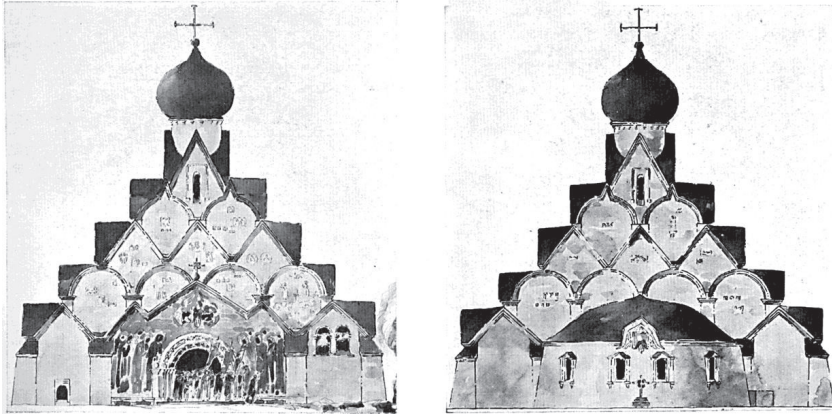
Arch. S.G.Klodt i A.P.Paszowski. Projekt cerkwi murowanej. Polecony do zakupu. Plan.
